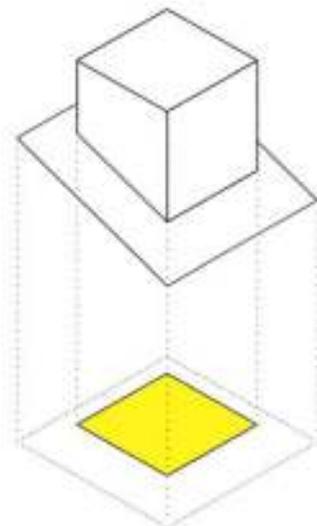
Skizze zur Erklärung einer bebauten Fläche
